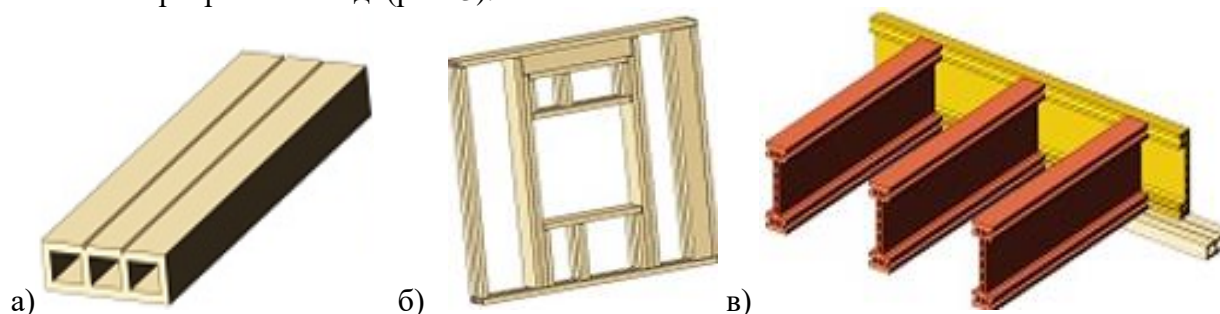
Укрупненные строительные конструкции из композитных материалов: а) плита перекрытия; б) стеновая панель; в) элемент балочного перекрытия
